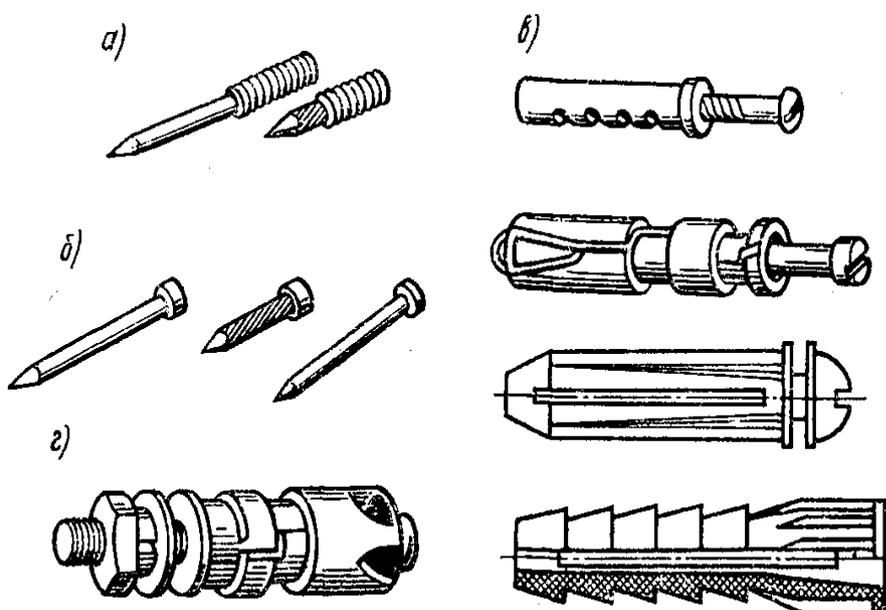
Дюбели: а - с наружной резьбой; б - гвоздеобразные; в - распорные; г - с распорной гайкой
